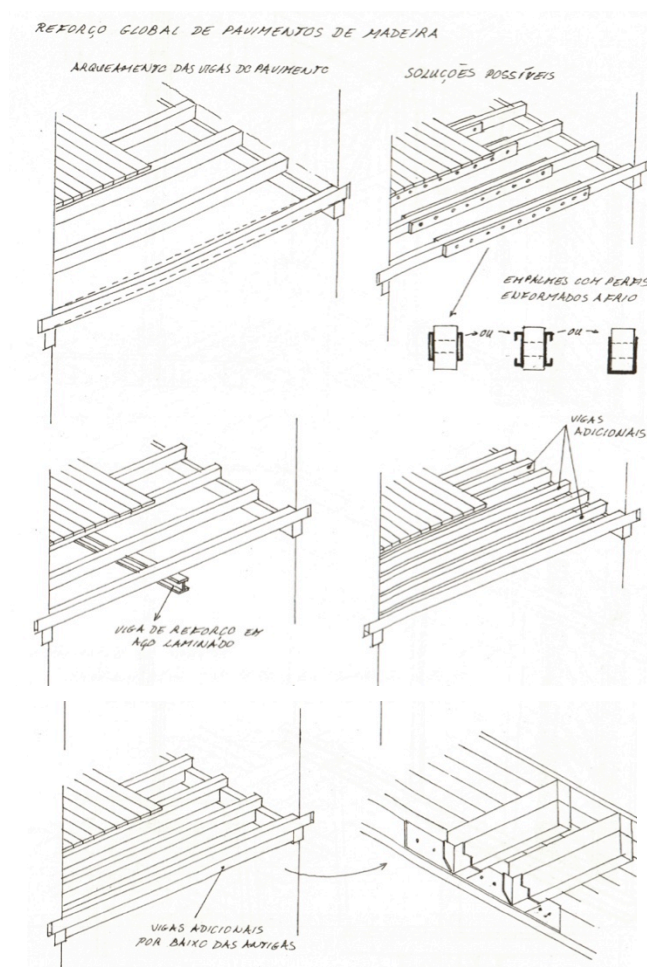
Reforço de vigas de pavimento (Mascarenhas, 2012).
